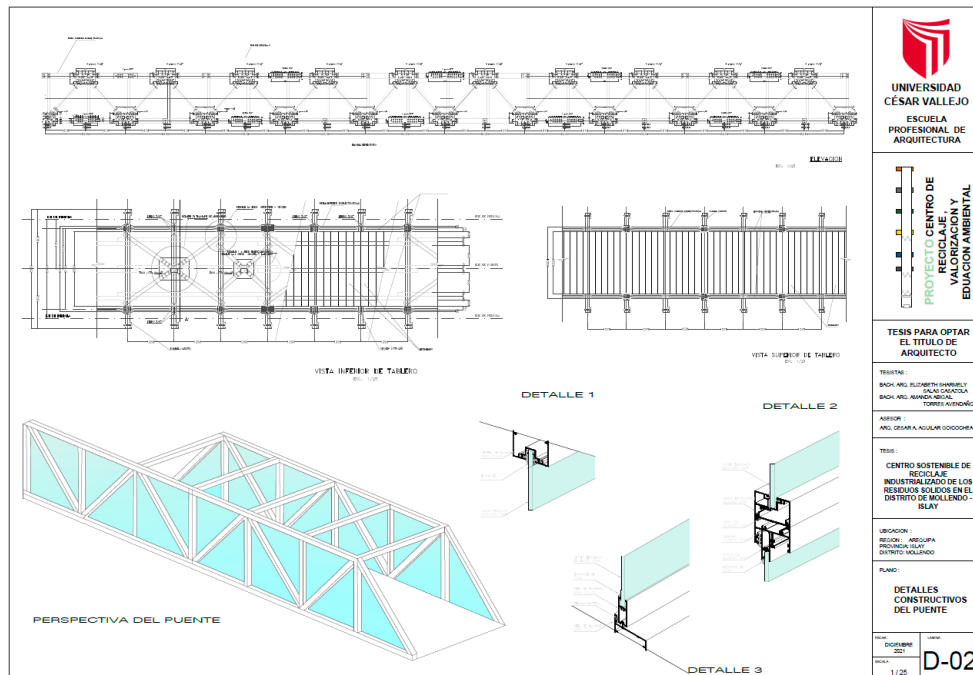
Plano de Detalles Constructivos de Puente FUENTE: Elaboración Propia
